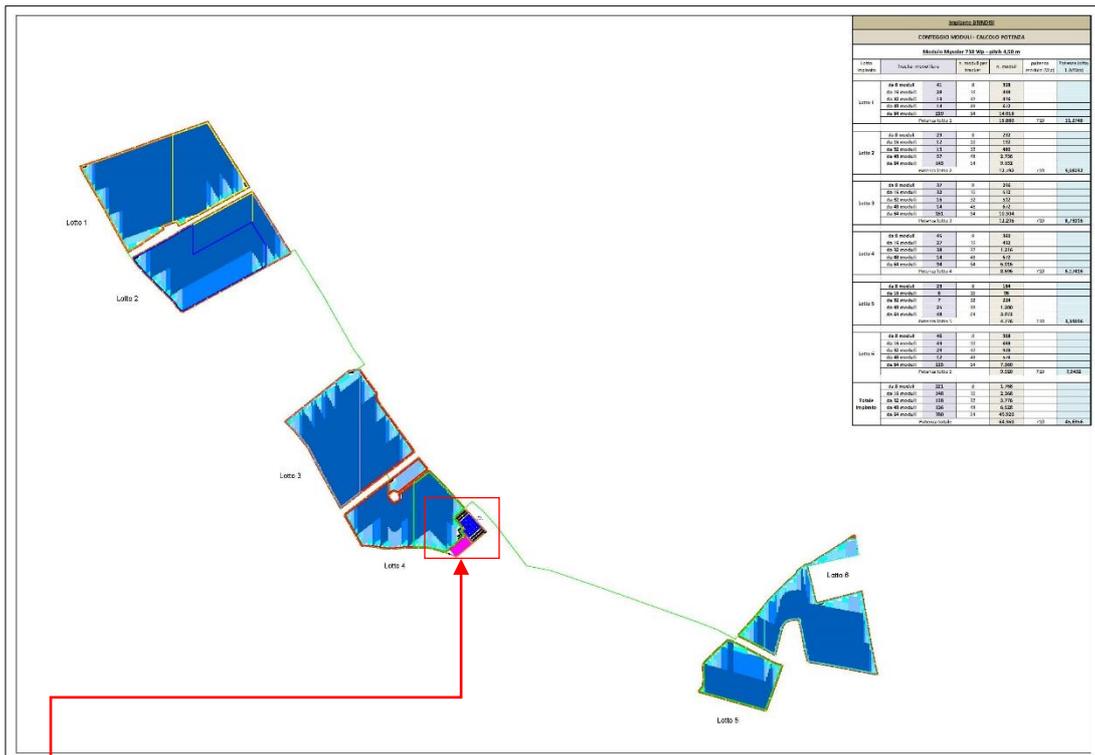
Planimetria generale dell'area di impianto, suddivisa su n. 6 subloti (layout impianto);
